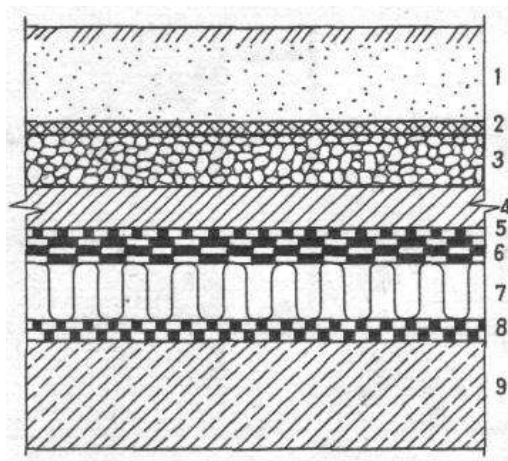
Пример конструкции крыши-сада: 1 — растительный грунт; 2 — фильтрующий слой; 3 — дренажный слой; 4 — защитный слой; 5 — разделительный слой; 6 — гидроизоляция; 7 — утеплитель; 8 — выравнивающий слой и пароизоляция; 9 — несущая конструкция
